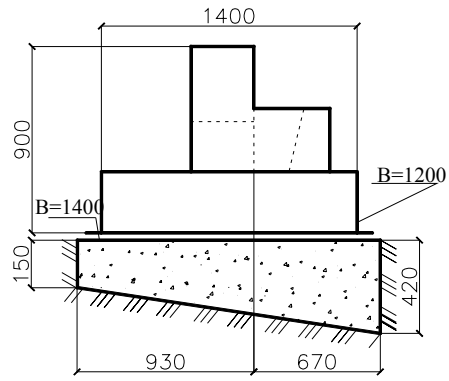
Блочний ступінчатий фундамент з бетонною підготовкою
